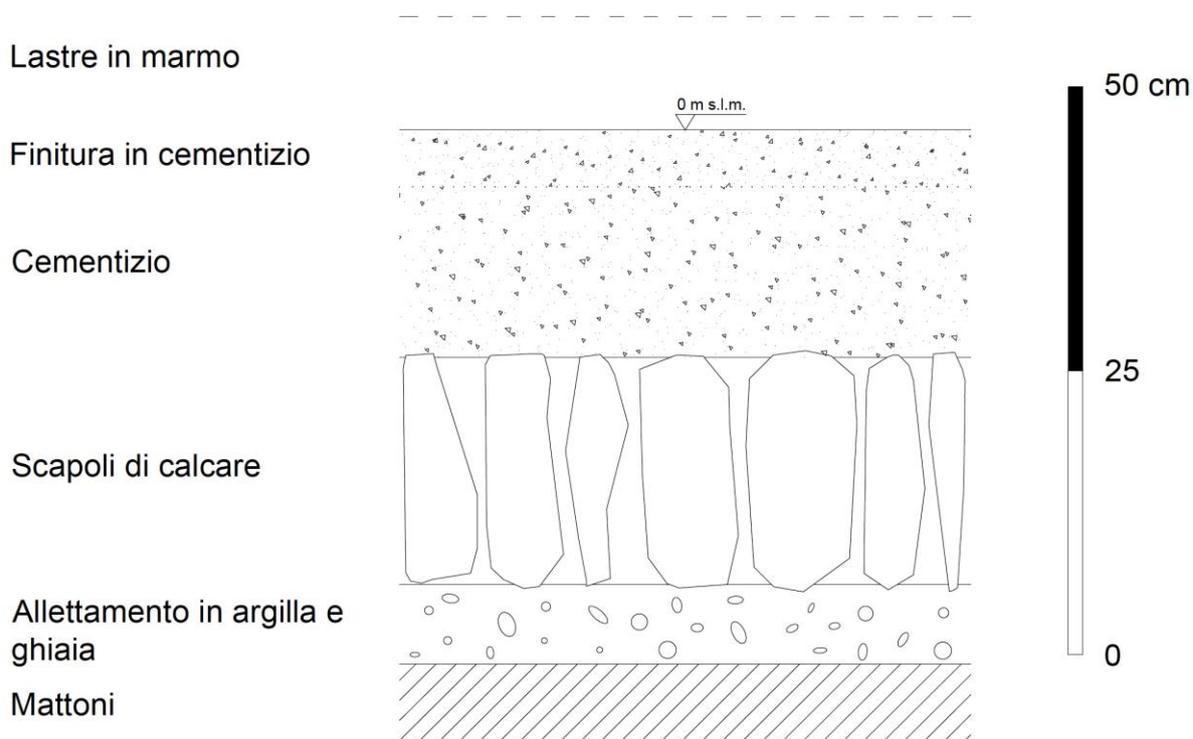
Aquileia, teatro romano: sezione ricostruttiva della sequenza preparatoria per il pavimento in lastre dell'orchestra.
